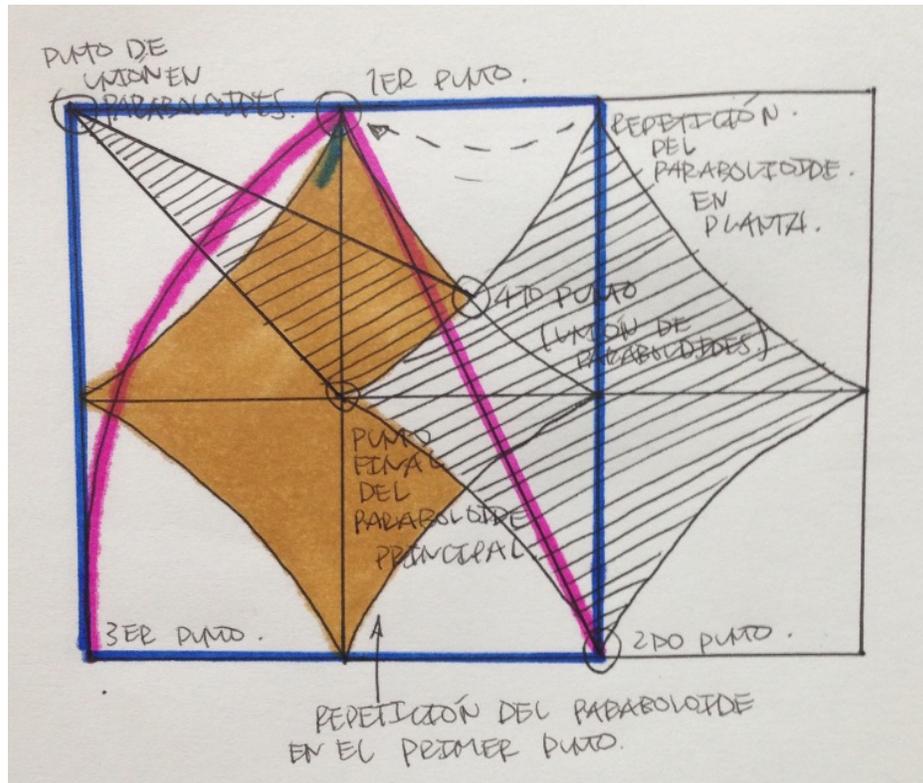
Sección aurea y experimentación del paraboloides en planta
